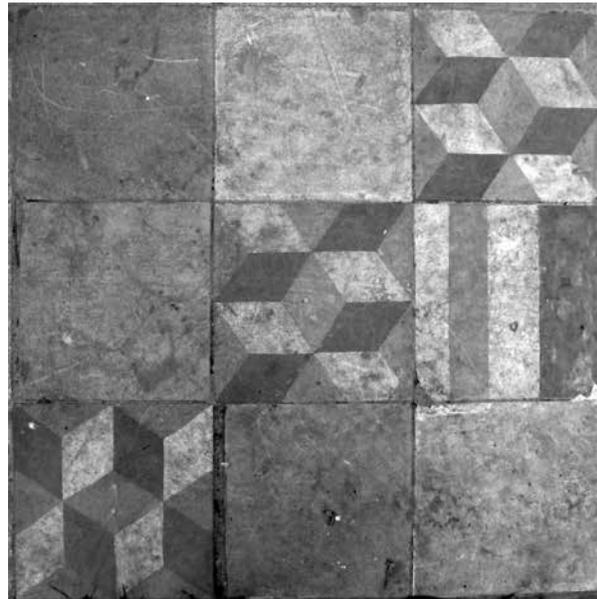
Detalle del pavimento del corredor del patio. Fotografía de Enrique Tovar.
